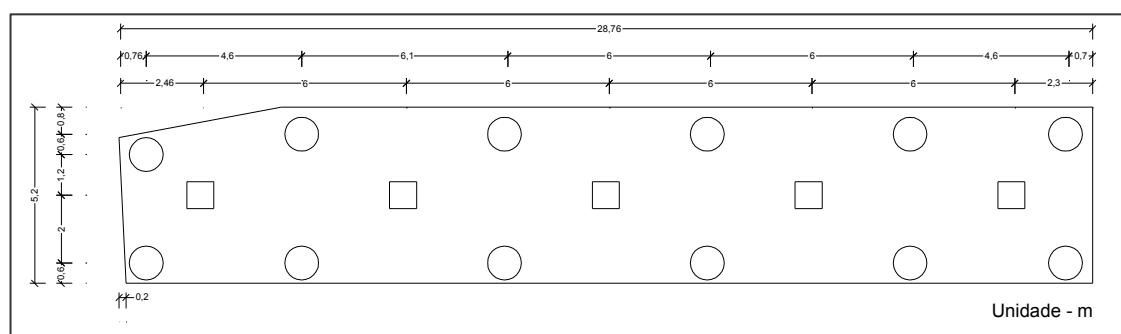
Planta do reforço das fundações do pórtico 8. Desenhado a partir de (Proman, 1989).
